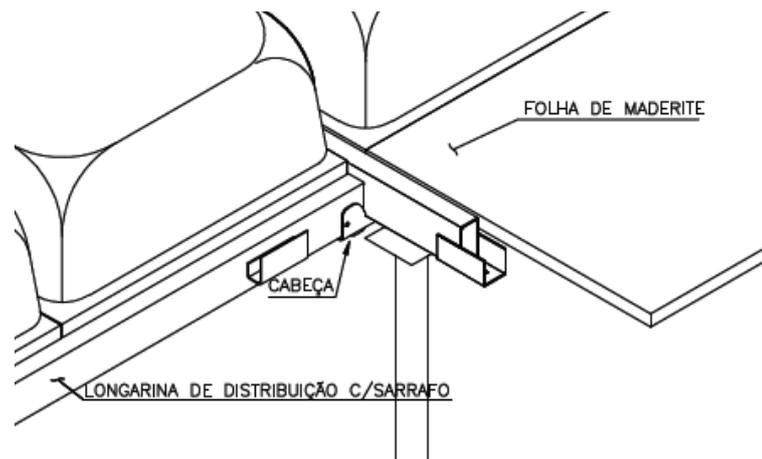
Ligação entre componentes (fonte: Impacto, 2013).
